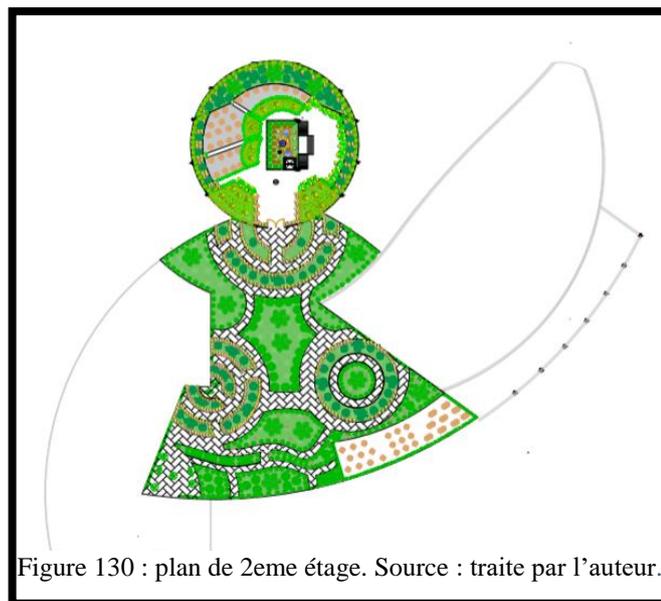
plan de 2ème étage. Source : traite par l'auteur.
